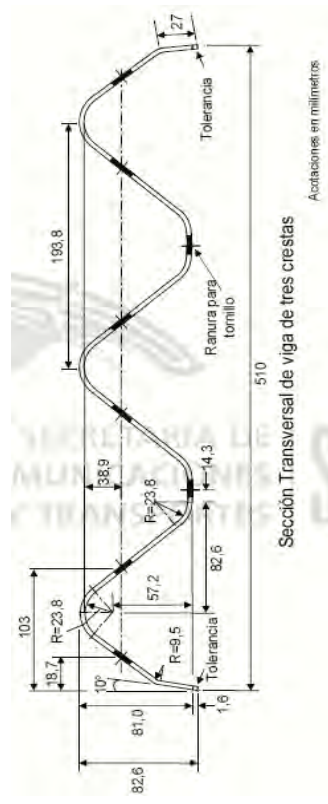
Sistema de defensa con vigas acanalladas de tres crestas
